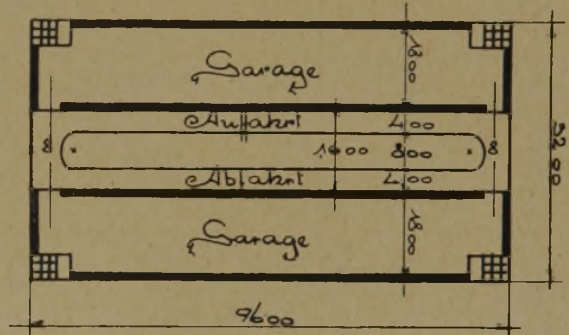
Prinzipskizze. Innere doppel-läufige Wendelrampe.
